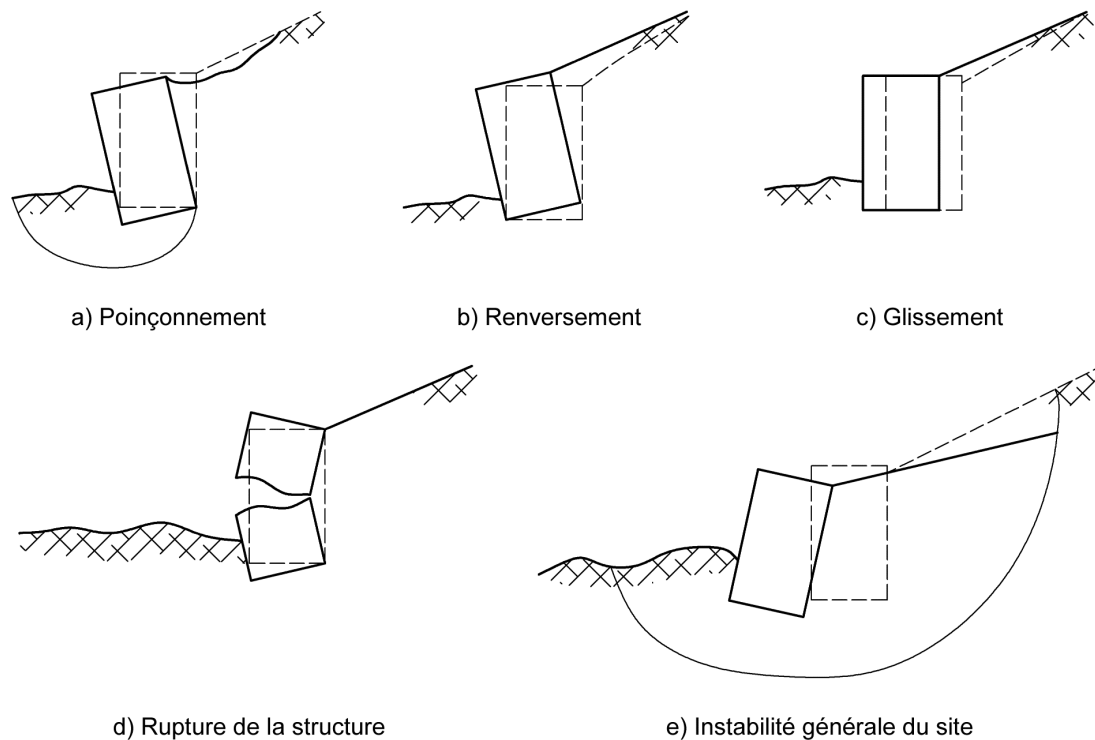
Mécanismes de ruine à considérer pour les murs de soutènement
